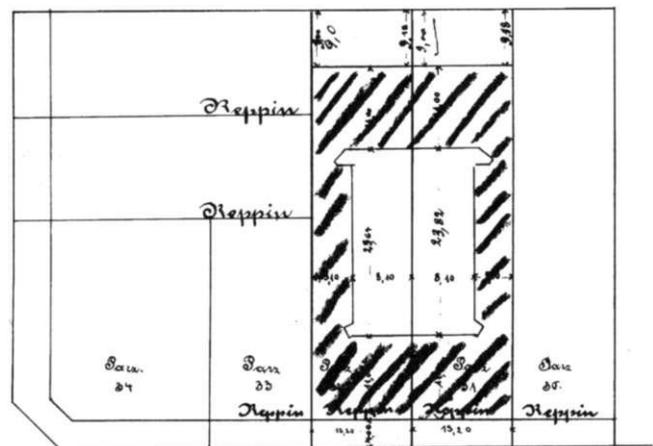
Lageplan Immermannstraße 34 und 35, Grundrißtyp A
